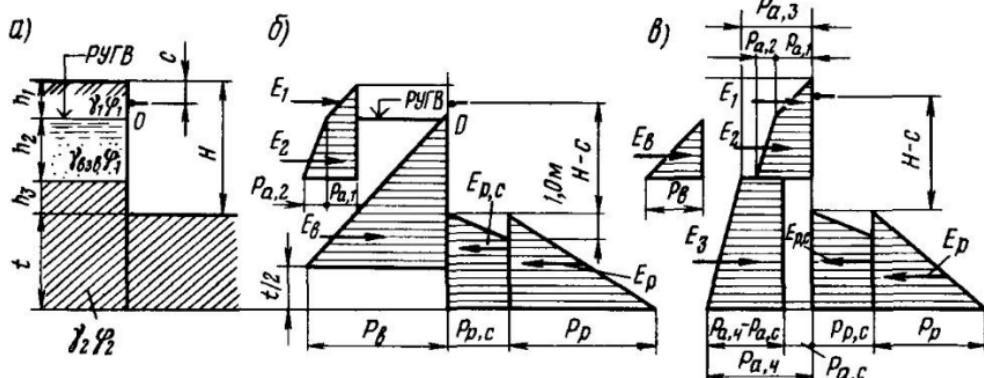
Схема для расчета стенок с одним ярусом креплений в связных грунтах:
